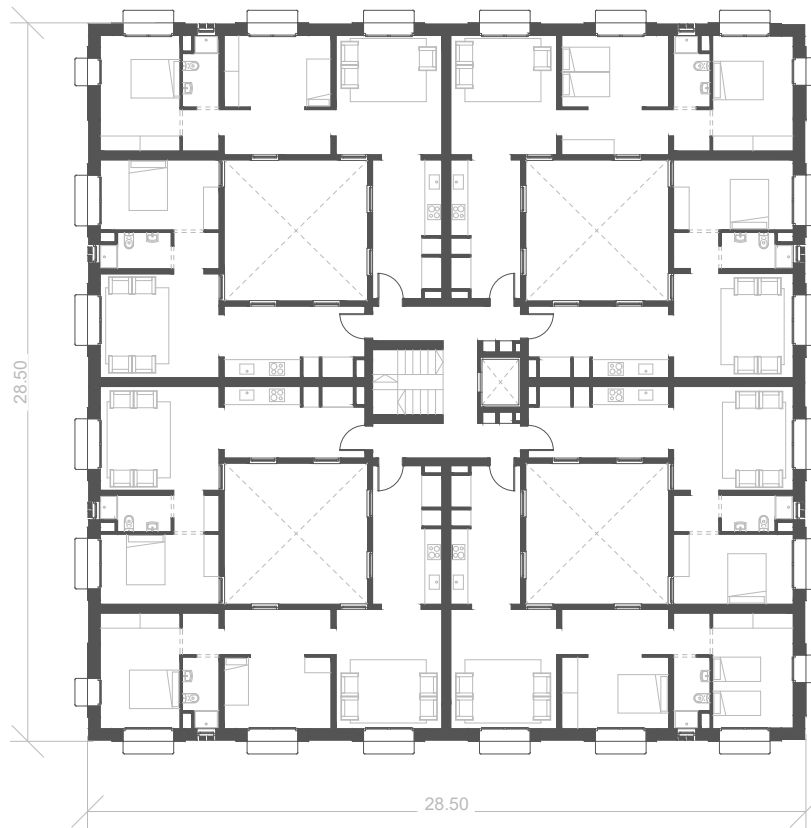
\_ Planta tipo 24 VPP en Ibiza. 08014 arquitectura. Editado propio. E: 300
